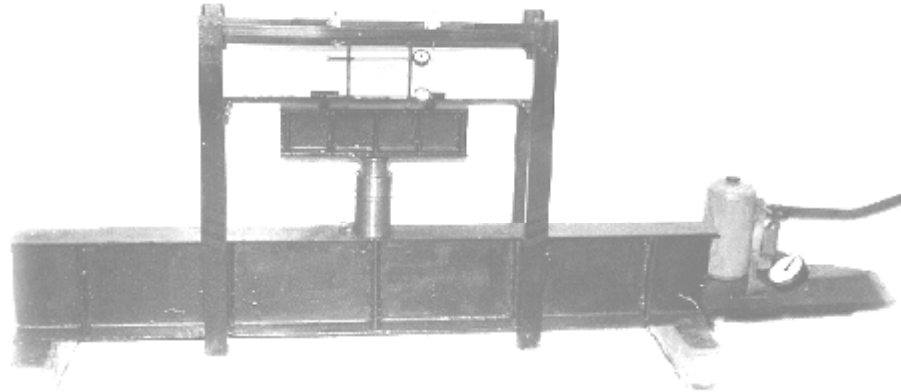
Общий вид экспериментального стенда при испытании балки с разрушением по нормальному сечению
